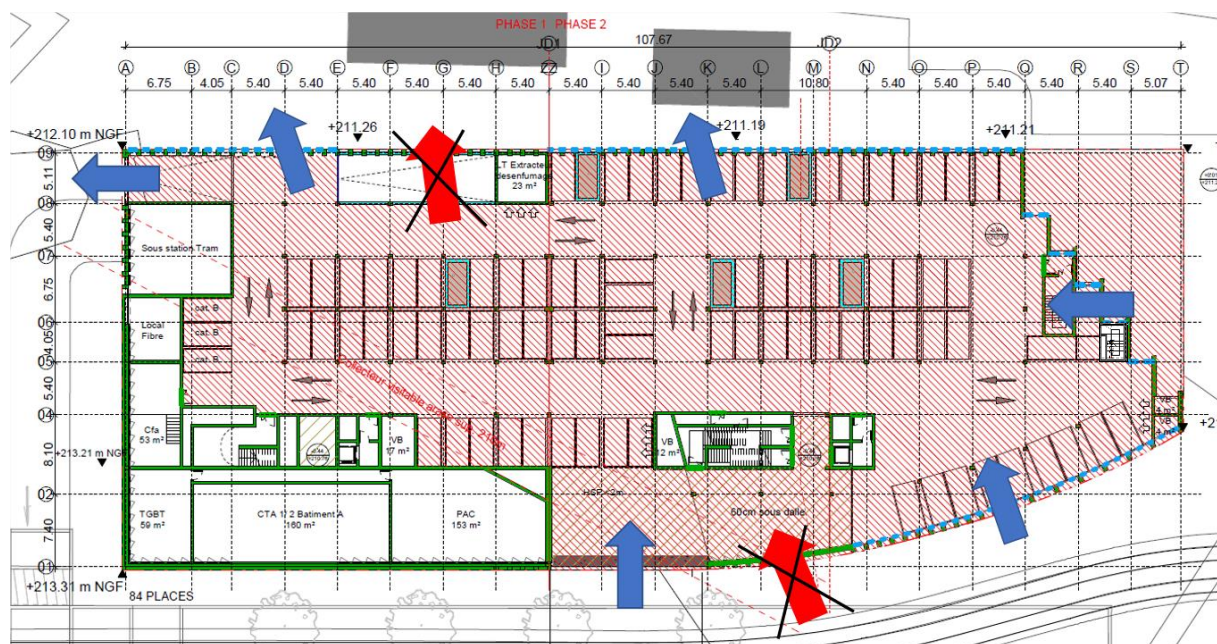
Plan du rez-de-chaussée « bas » - zone de passage des eaux
